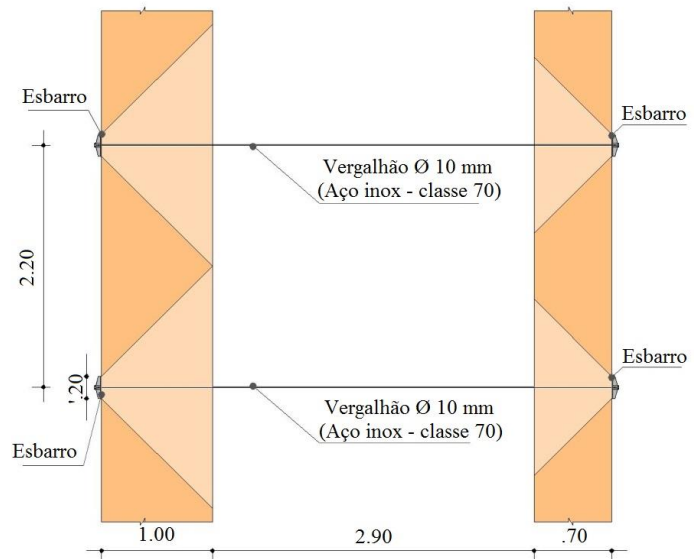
Esquema representativo do espaçamento dos tirantes, em planta (dimensões em metros).
